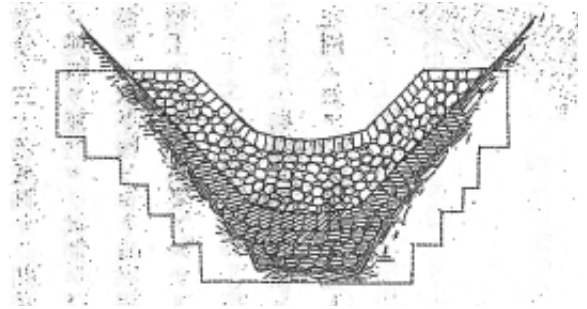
池田の帰朝報告書の正面図堰堤の平面図と側面図
